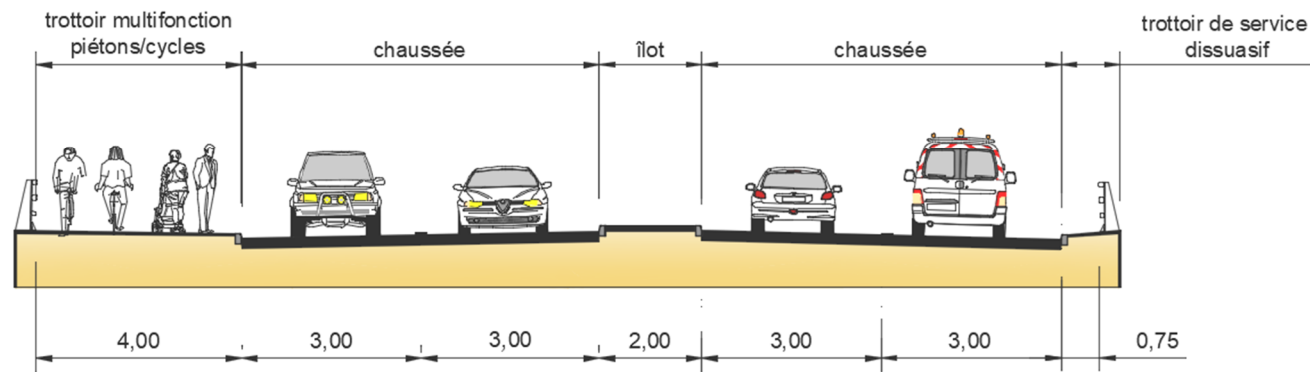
Profil en travers type du barreau de la solution retenue (sous-variante 3)
